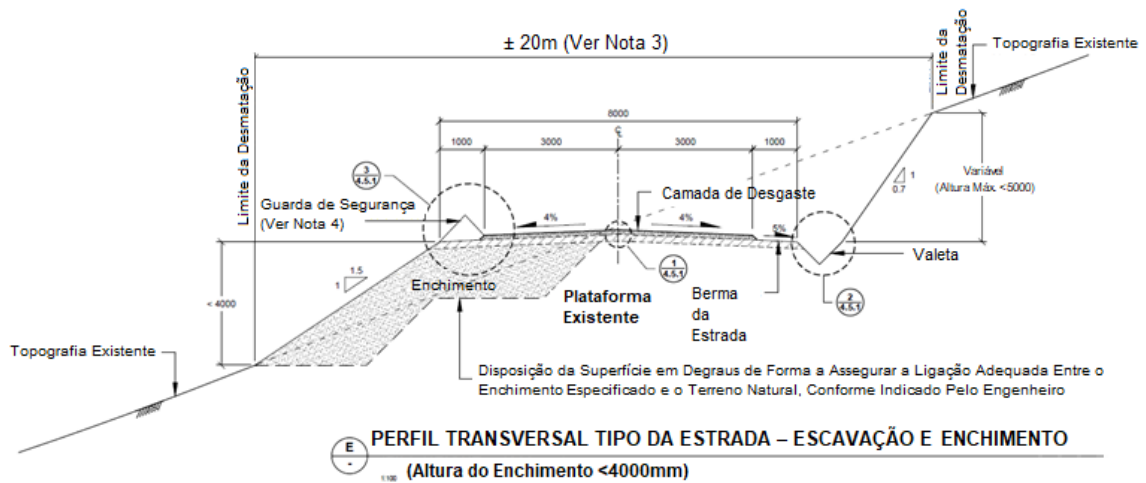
Secção transversal da estrada – escavação tipo 3.
